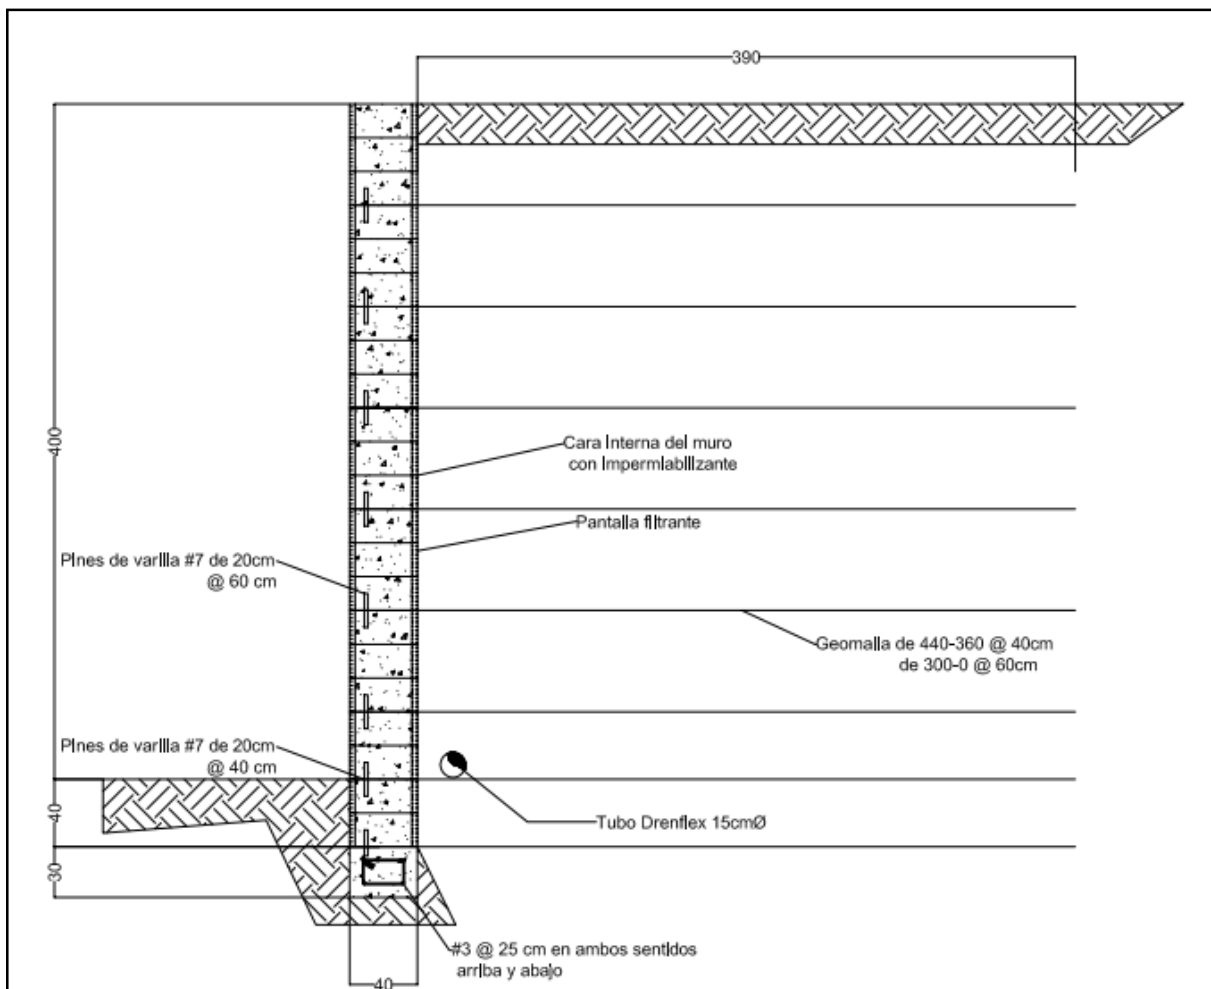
Esquema muro suelo reforzado 4 m cotas en cm
